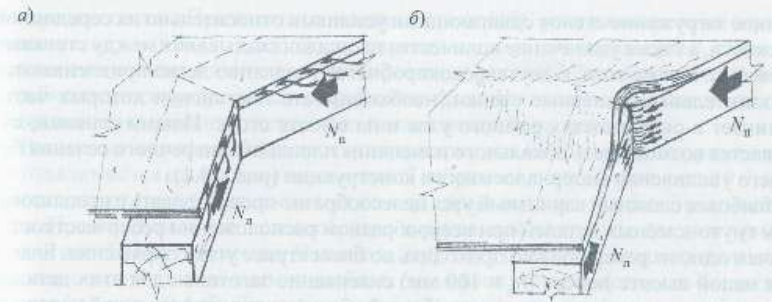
Схемы силовых потоков и последовательности включения в работу элементов карнизного узла в сжатой зоне: а – переход усилий с поясов на фанерные стенки через клеевые швы; б – смятие поясов под углом после отрыва и потери устойчивости стенок
